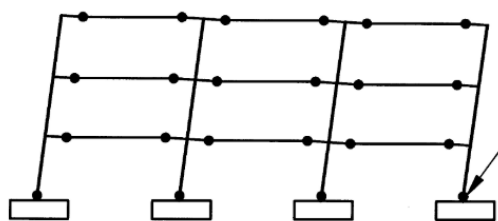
Mecanismo deseable de formación de rótulas plásticas en porticos prefabricados de concreto.
